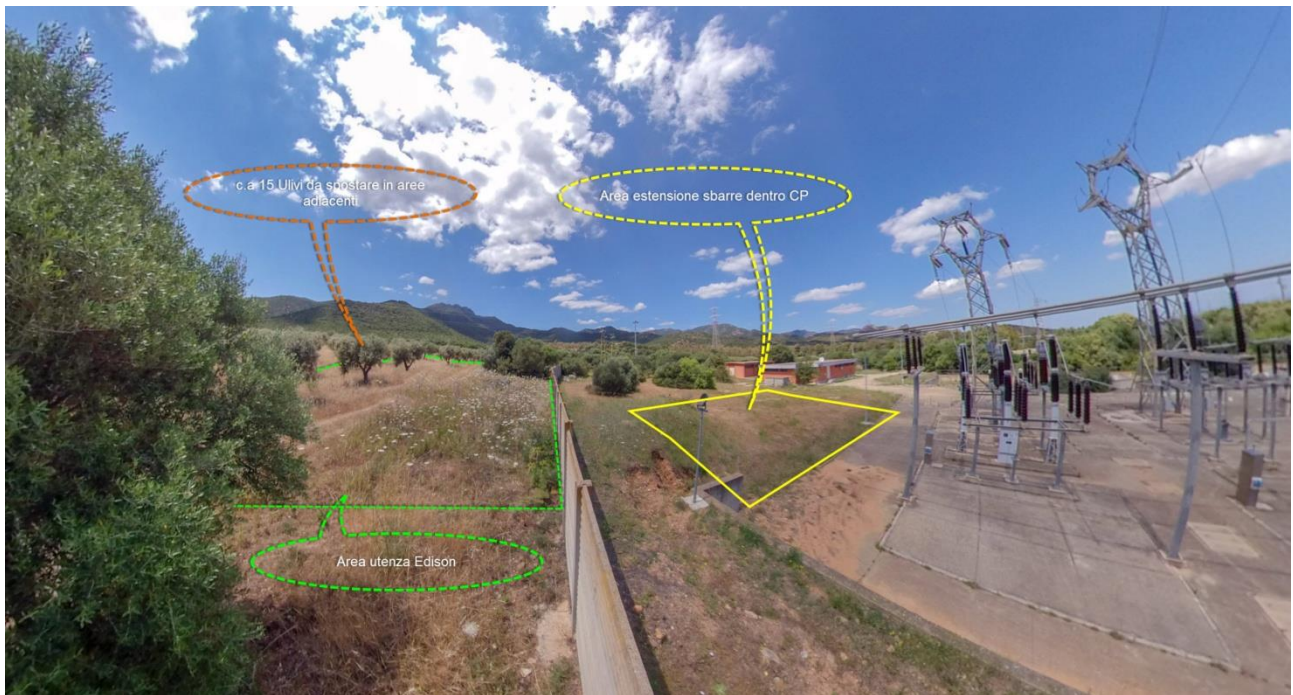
Posizione stazione utente Edison rispetto a CP Sarroch esistente
